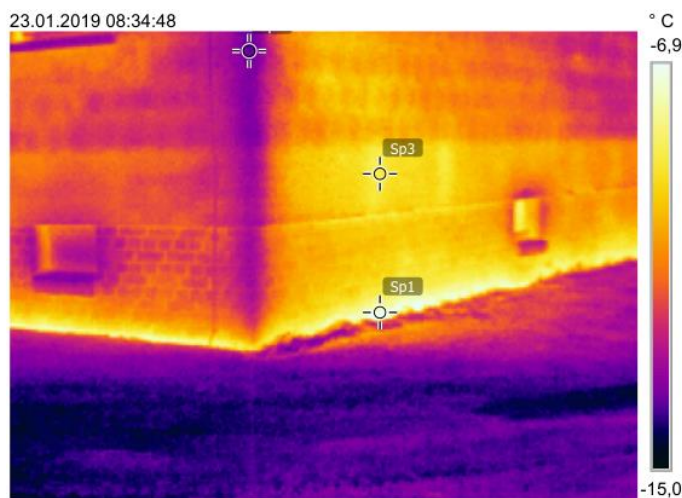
Giebelwand Westseite konstruktive Wärmebrücke Wandanschluss
